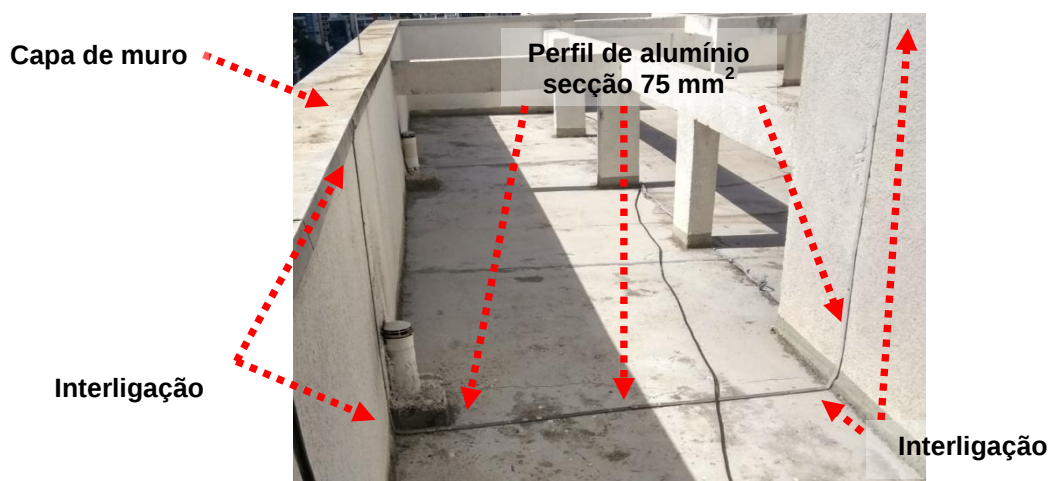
e 15: Malha captora natural - Capas de muro instaladas no entorno da cobertura da edificação, em cota mais baixa.
